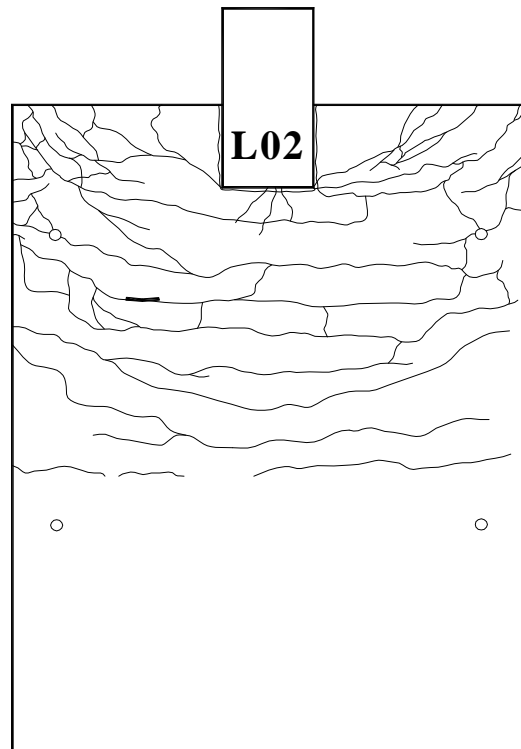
Padrão de fissuração da face inferior da laje – L2
